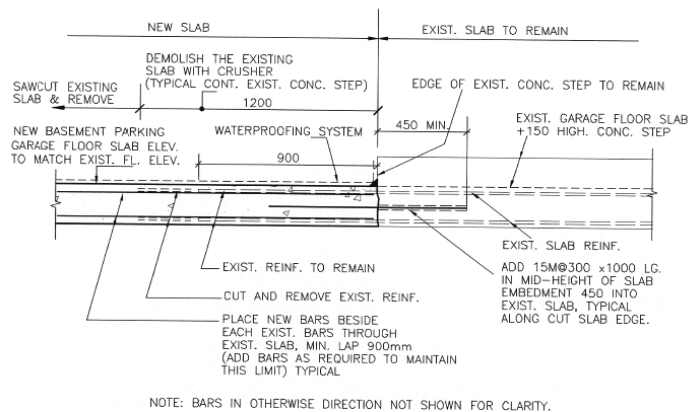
Îmbinarea noului planșeu din beton armat cu cel existent - secțiune tipică
